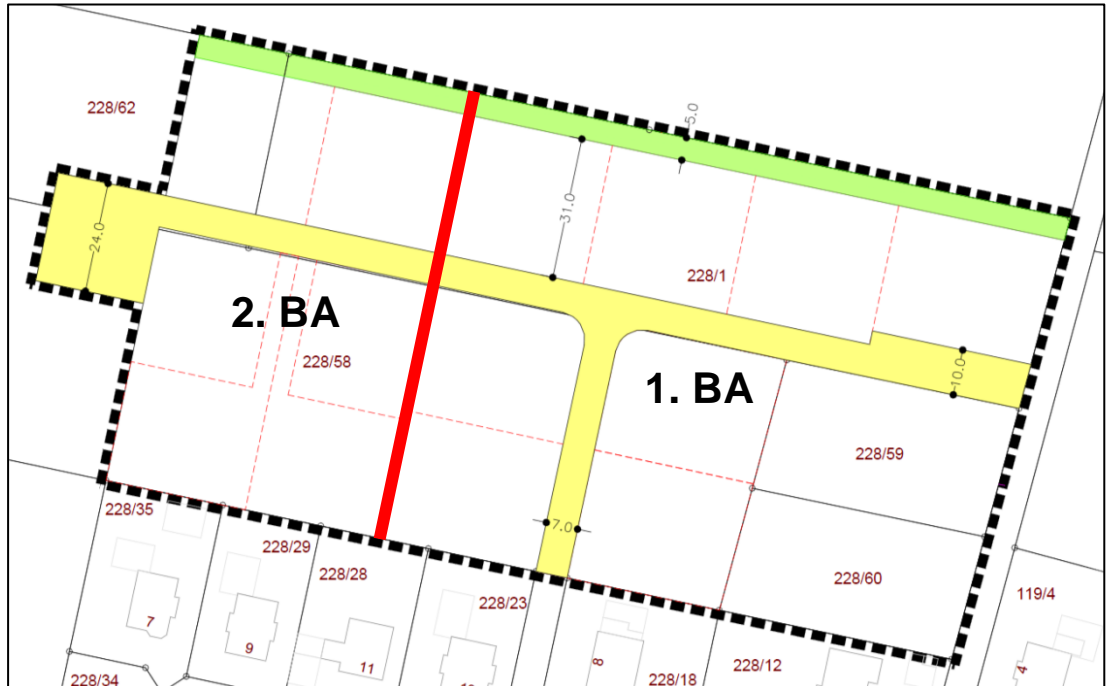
Mögliche Bauabschnitte im Plangebiet
